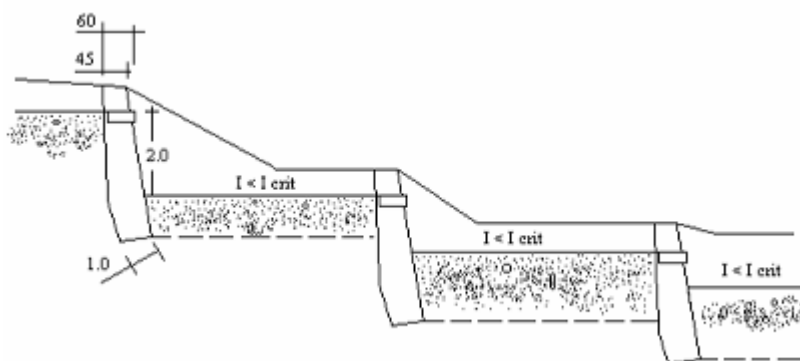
Estructuras transversales para reducción de la pendiente
